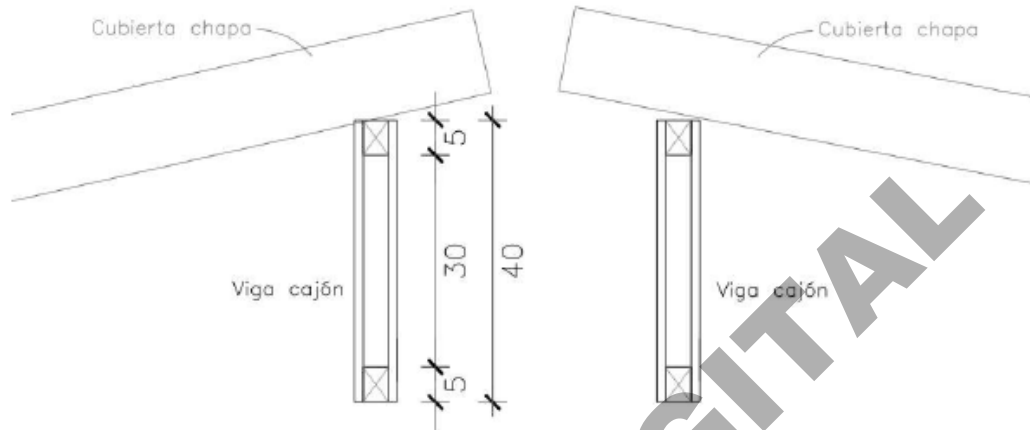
Apoyo cubierta en cumbre vigas cajón (Tip. en segunda planta)
